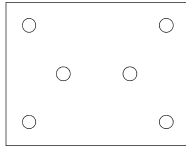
Panneaux ISOVER TF de dimensions 1200 × 600 mm - plans de chevillage en plein et en joint
